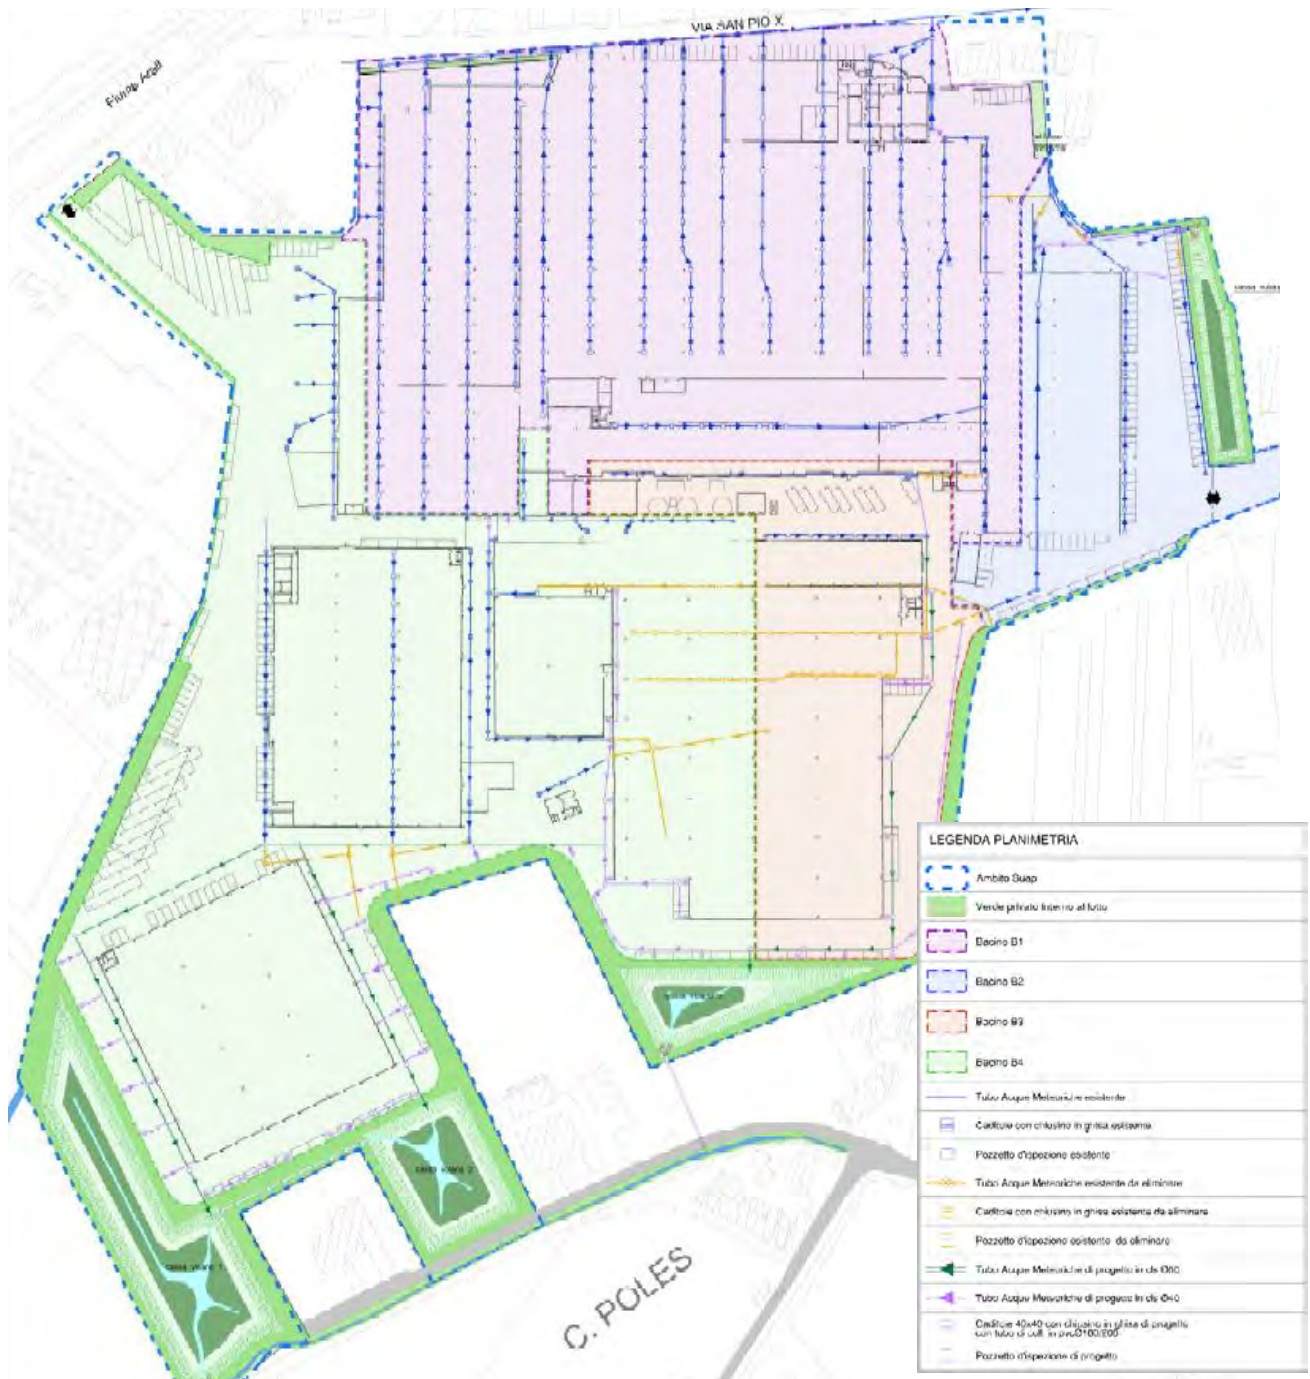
Estratto tav.A-025 Planimetria reti tecnologiche acque bianche
